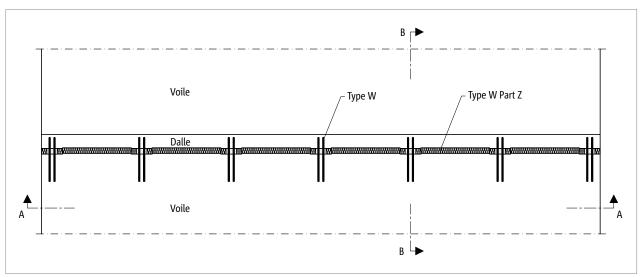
Schöck Sconnex® type W : raccordement entre le mur et la dalle sus-jacente - montage en tête de mur
